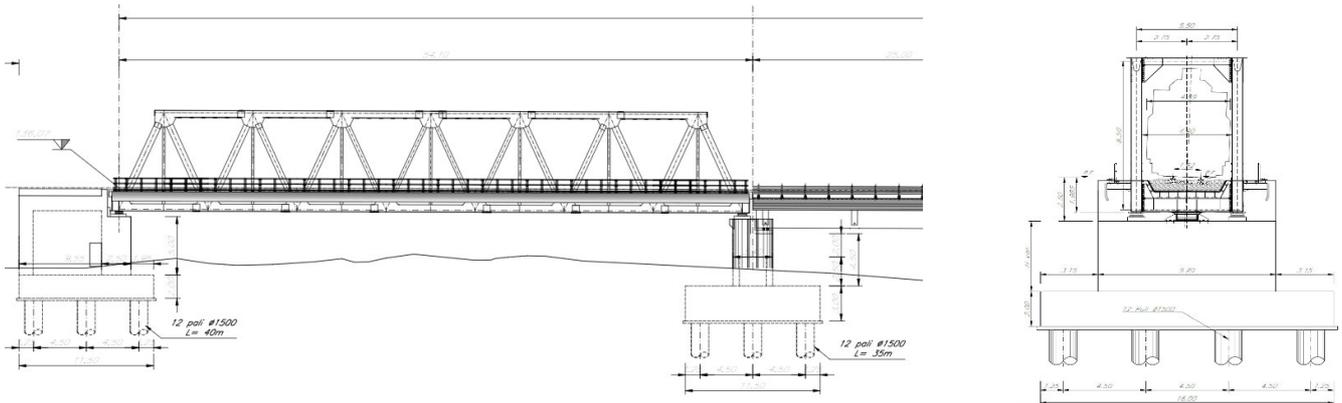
VI10 – Impalcato con travata reticolare metallica - Profilo longitudinale (sx) – Sezione trasversale (dx)
